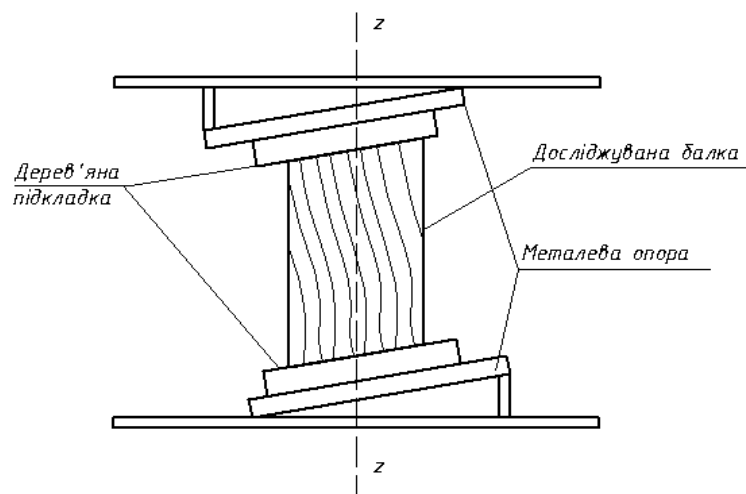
Схема обпирання зразків балок другої групи з розташуванням дерев'яних підкладок відносно перерізу балки
